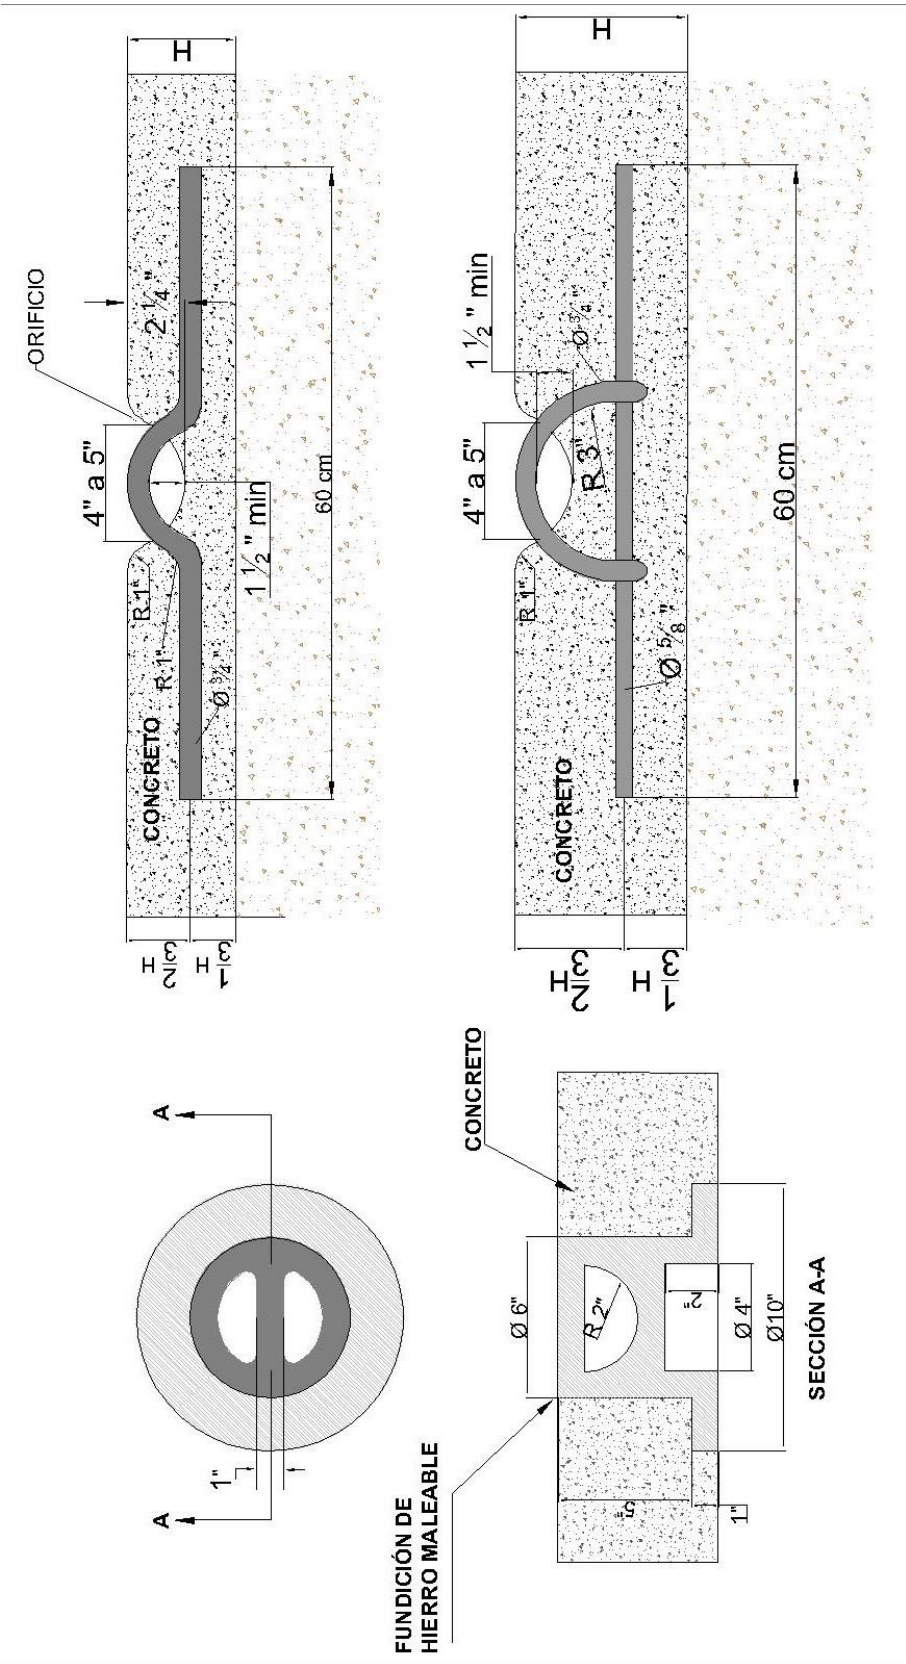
Dispositivos fijos de amarre para superficies de pavimento rígido.
